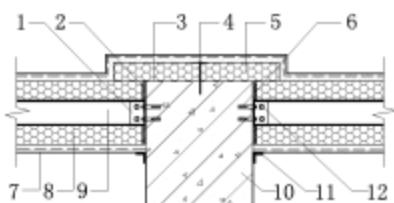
边柱外保温及与水平芯肋连接组合构造示意（水平剖面）
